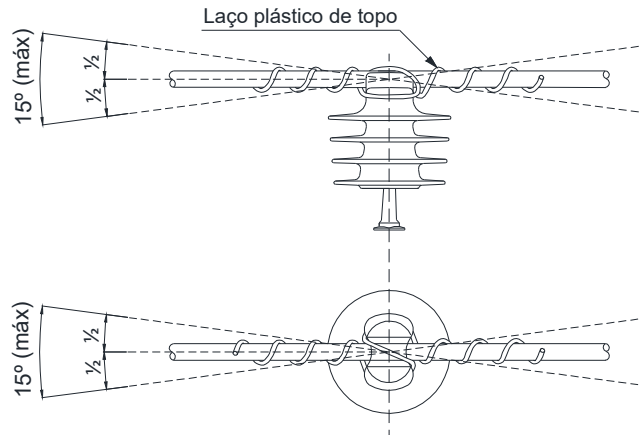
Amarrações e ligações – Amarração de topo do cabo protegido – Laço plástico
